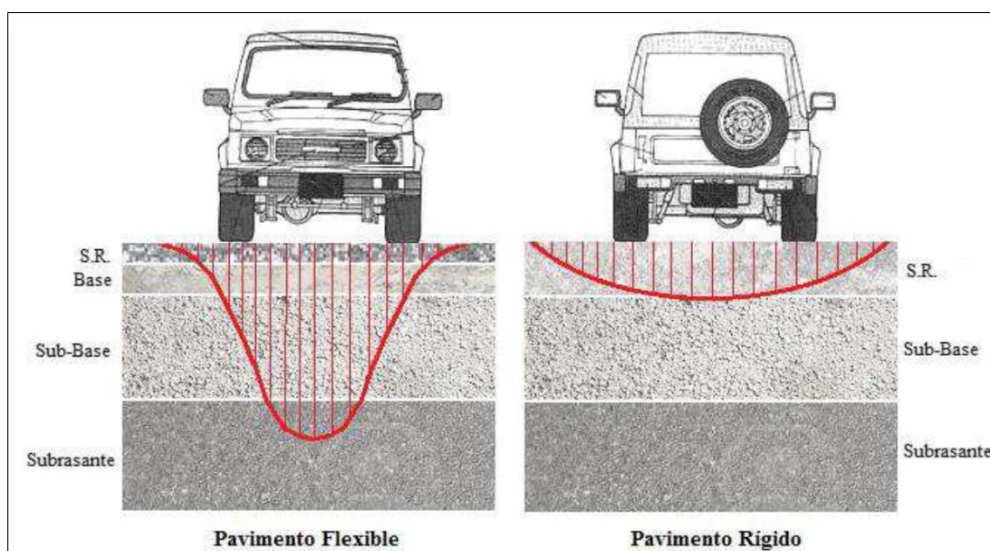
Comportamiento estructural de los pavimentos rígidos y asfálticos.
